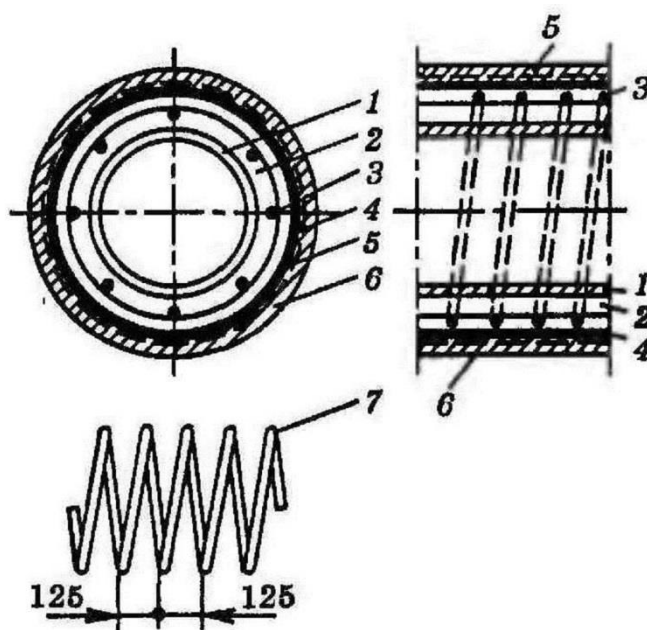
Конструкция монолитной армопенобетонной изоляционной оболочки
